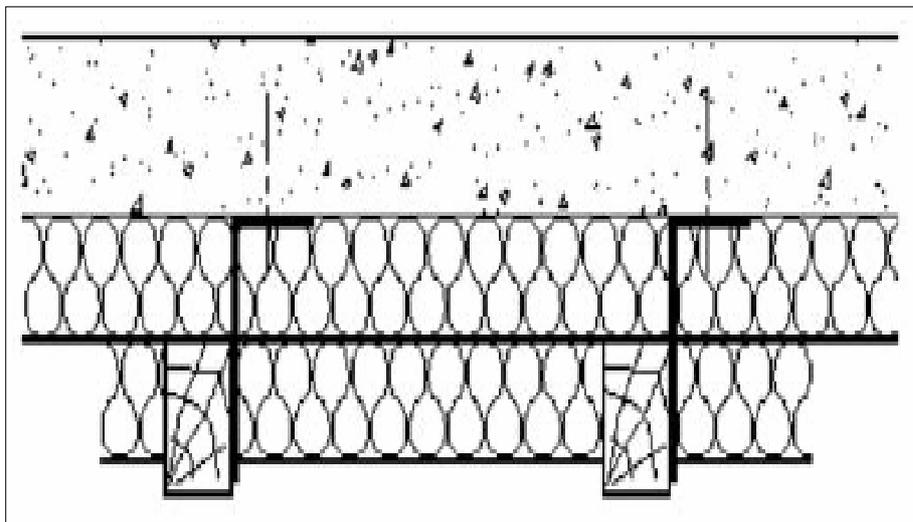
Colocación de aislamiento en dos capas entre muro soportante y estructura que recibe el revestimiento.
